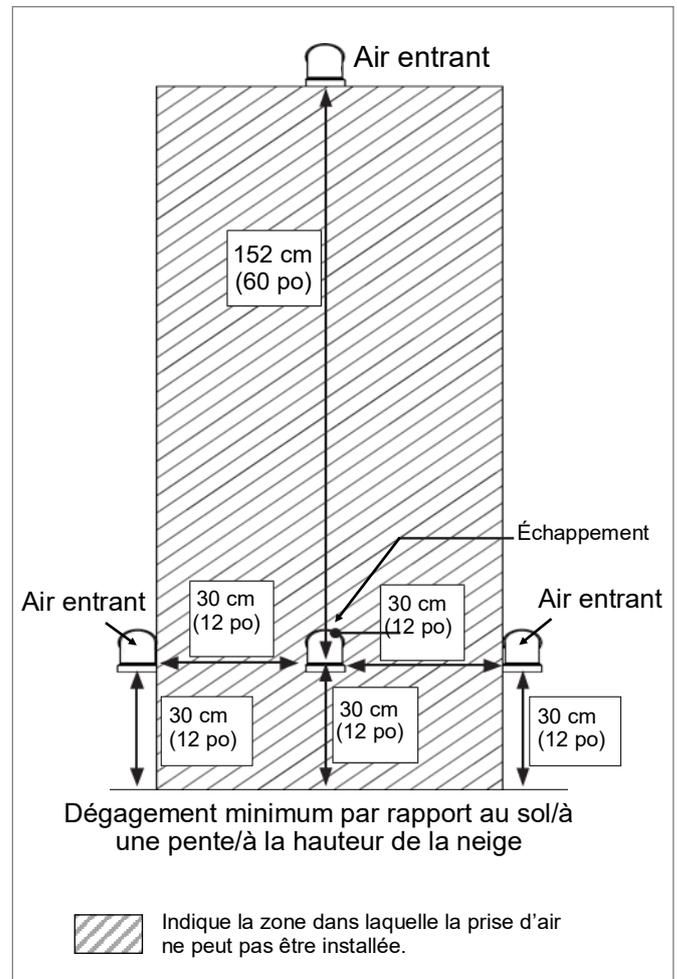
Conduit d'évacuation horizontal et tuyauterie d'air entrant
